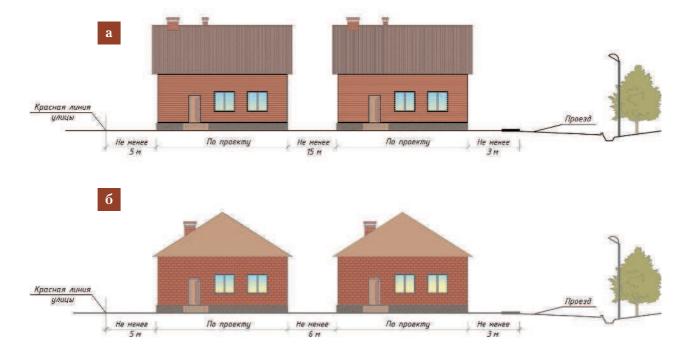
Нормативные расстояния между домами, красными линиями, проездами: a — дома с деревянными стенами; δ — дома с каменными стенами и монолитными перекрытиями
